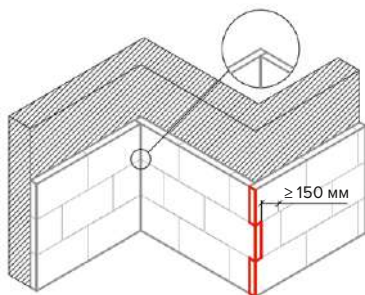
Зубчатая перевязка плит на внутренних и наружных углах здания
